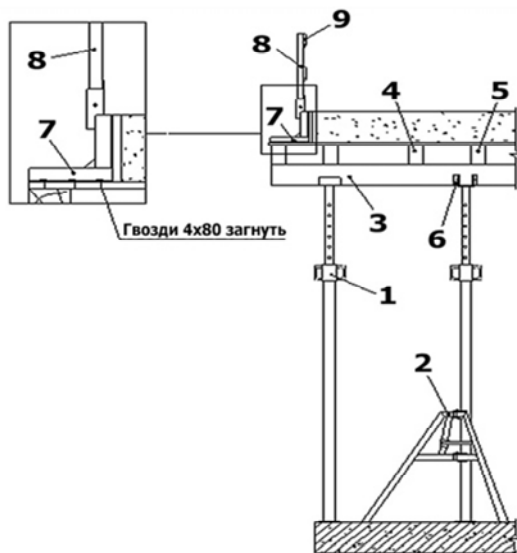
Схема устройства опалубки контура монолитного перекрытия:
